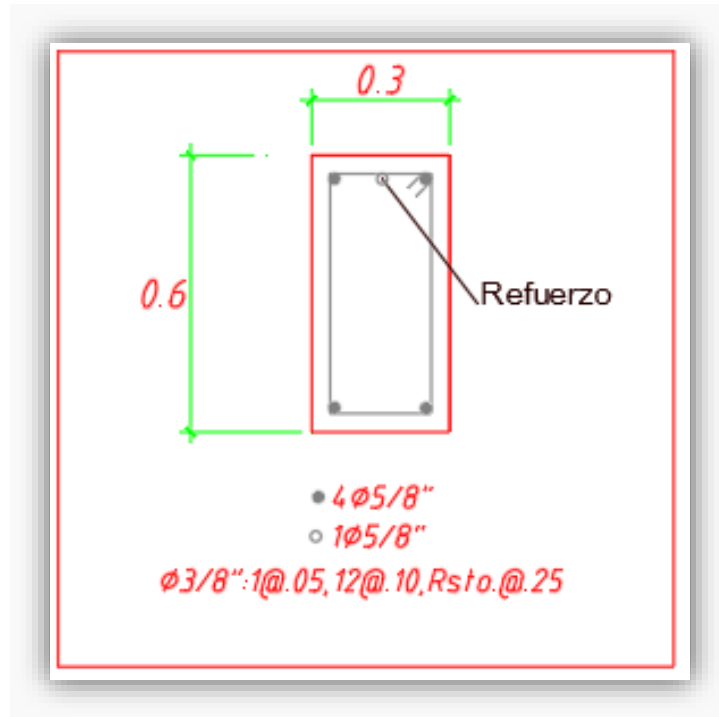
Detalle de refuerzo en vigas pisos 4 al 6
